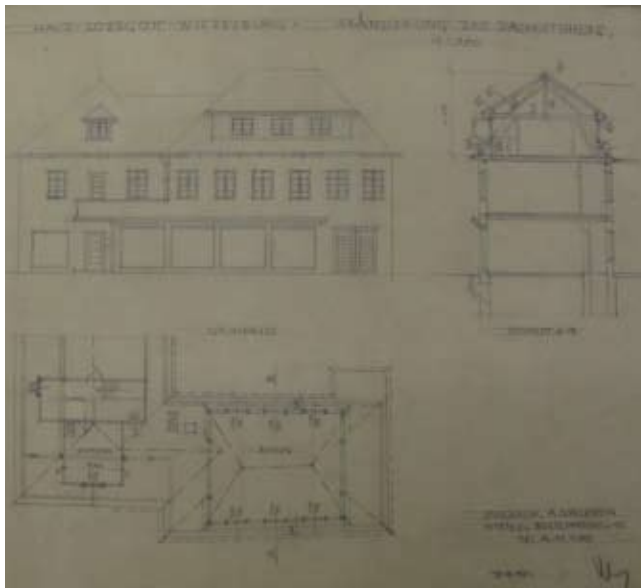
Plan 12.6: Anton Valentin. Haus Lossgott – Wieselburg – Abänderung des Dachstuhles. Ansicht, Schnitt und Grundriss. Maßstab 1:100. 17. September 1930.
